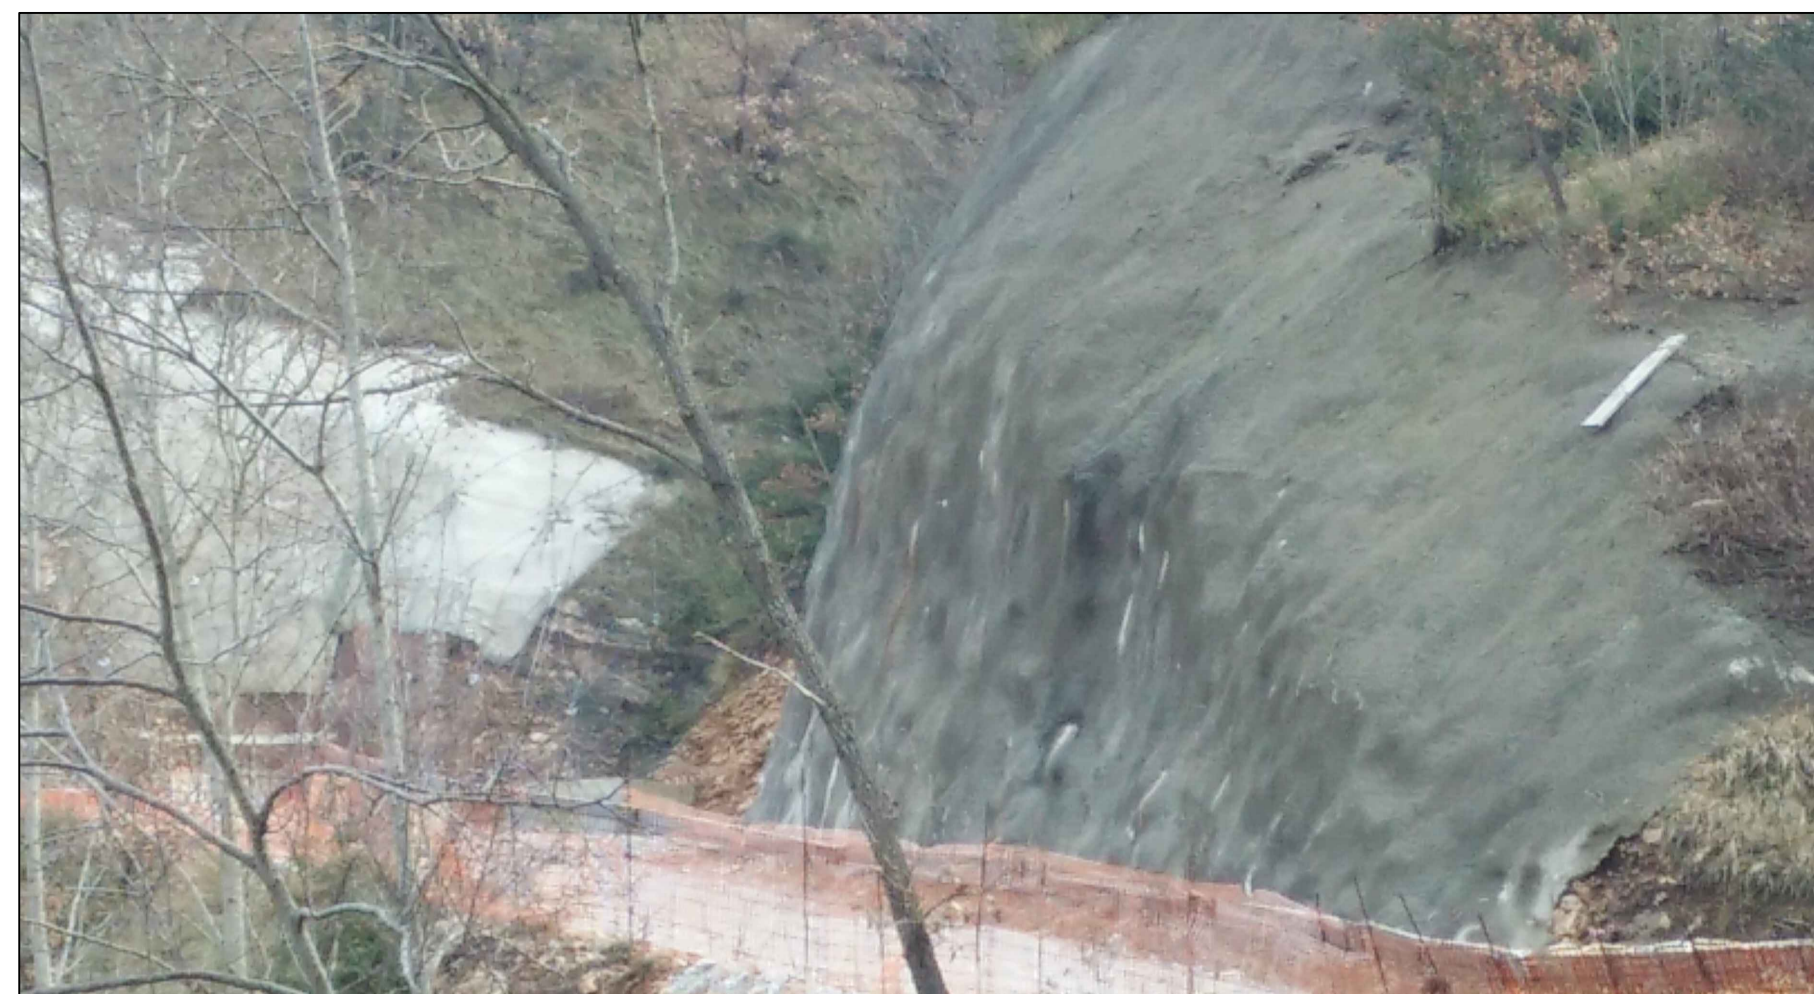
Vista parete rivestita in Spritz Beton lungo la strada di cantiere esistente
